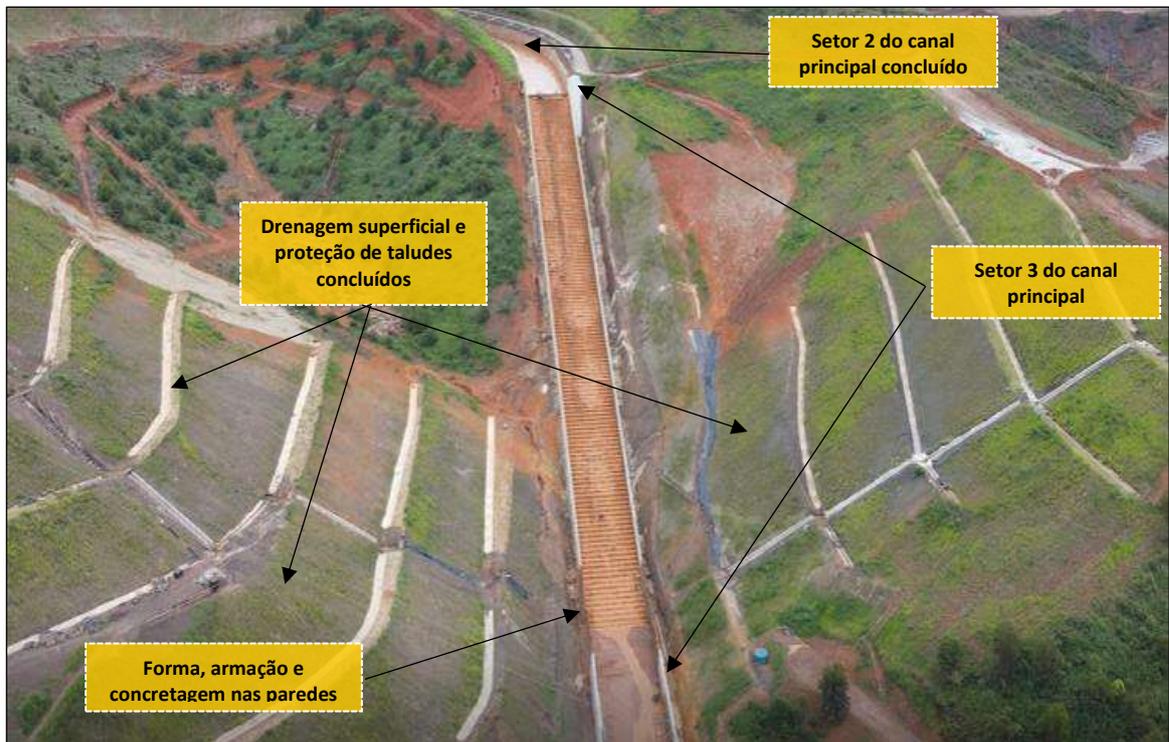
Vista do setor 3 do Canal Principal – paredes do canal em andamento – Data 04/01/23
